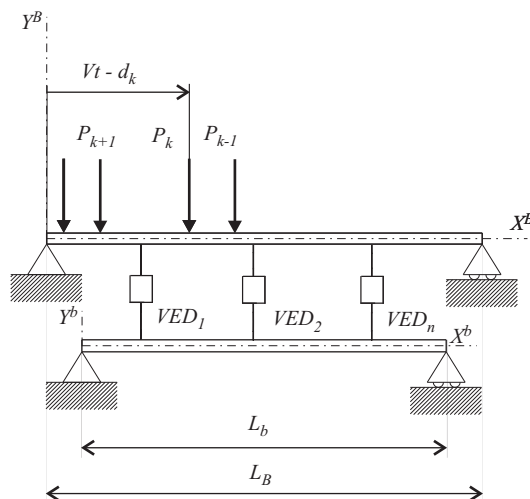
Modelo plano del puente y su sistema de reacondicionamiento
